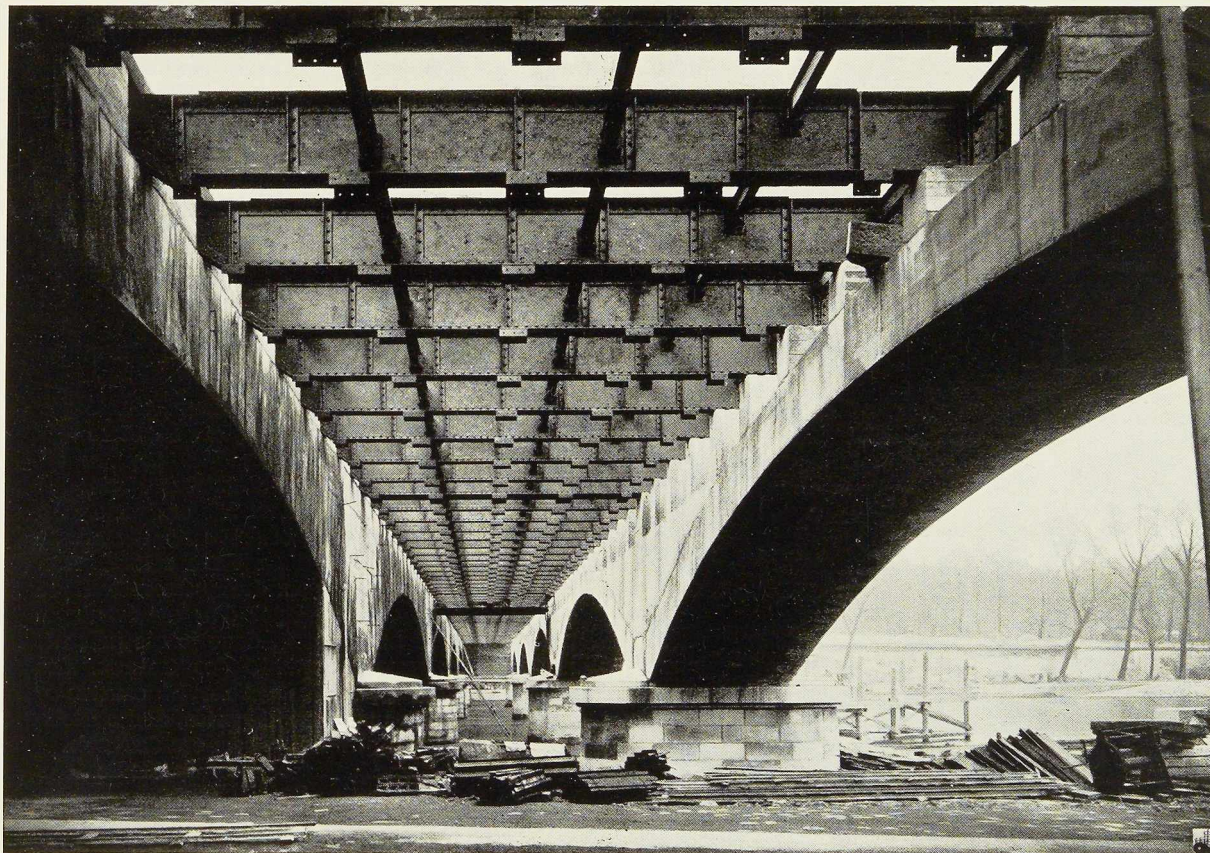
Les nouvelles arches du pont d'Iéna sont reliées au pont existant par des poutres composées en acier, recevant une dalle en béton. On note les goussets auxquels seront suspendus les tirants des quatre passerelles destinées aux canalisations.
